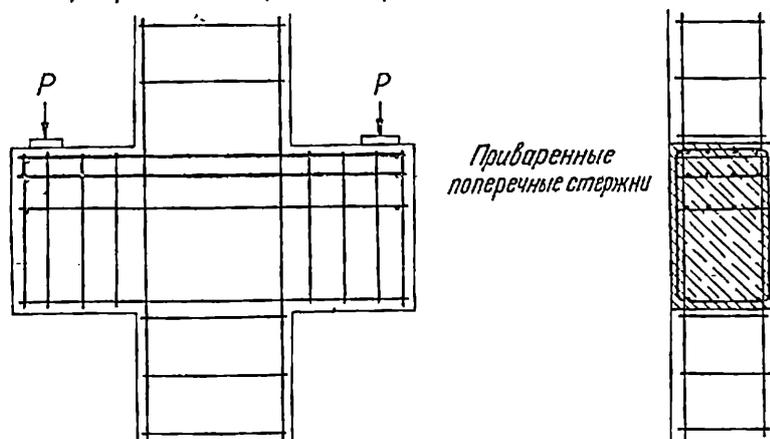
2. Армирование коротких консолей (колонн, несущих подкрановые балки.)
